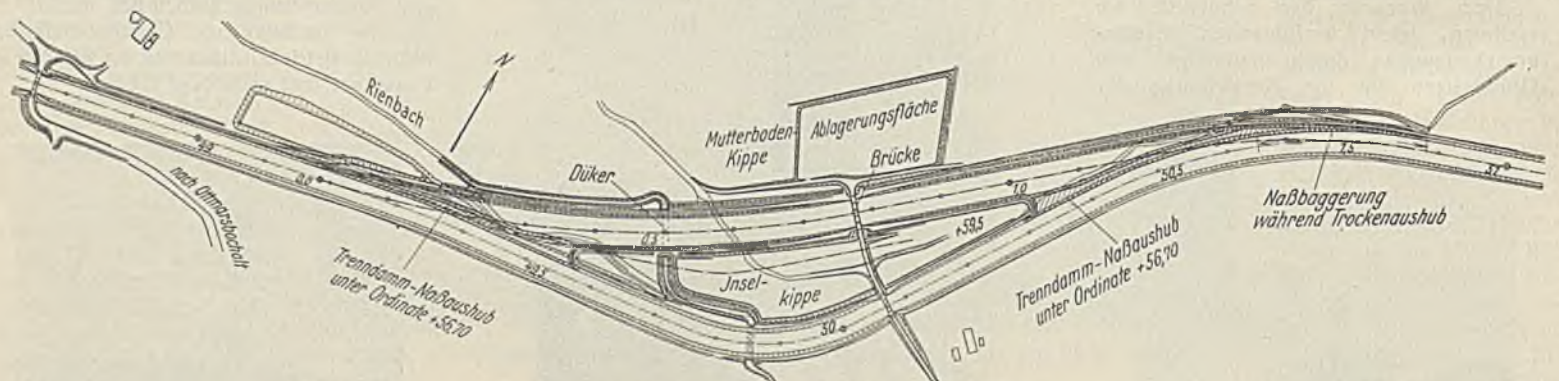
Lageplan der 2. Fahrt am Rienbach.
